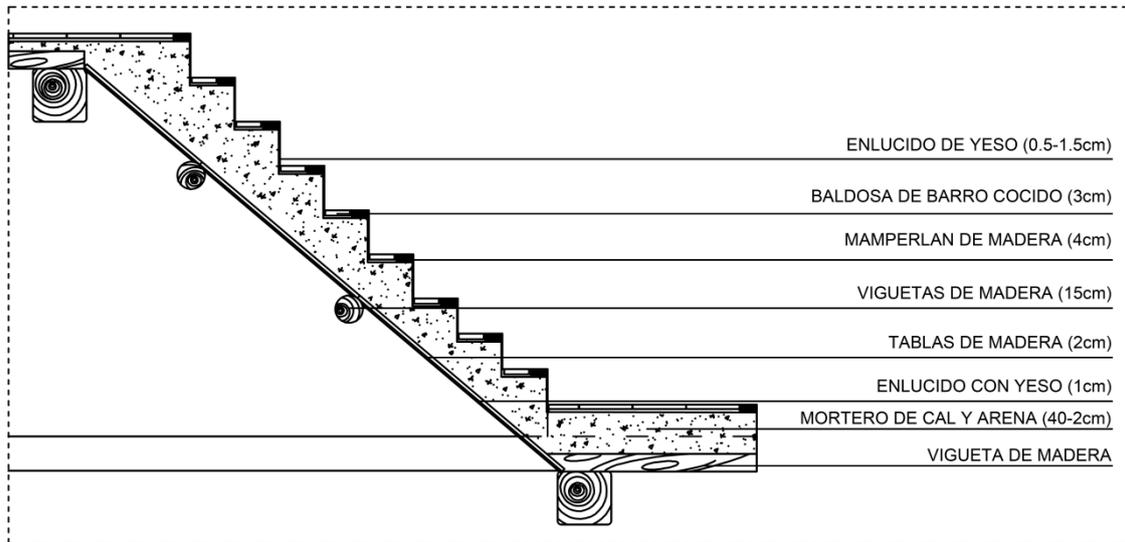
Detalle constructivo de la estructura de madera de la escalera en sección
